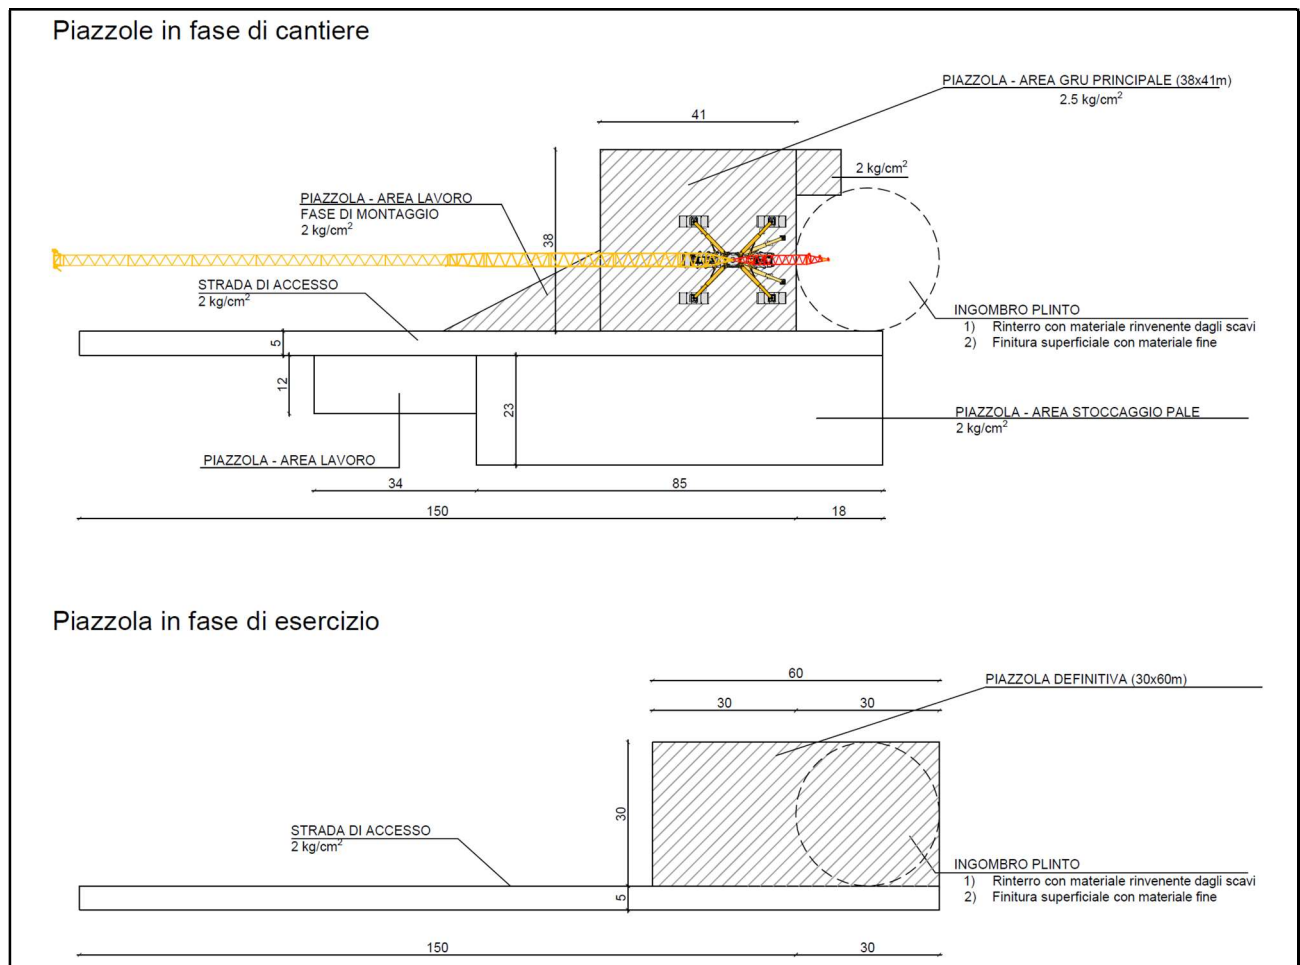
Planimetria piazzola tipo per la fase di installazione e fase di esercizio e manutenzione
